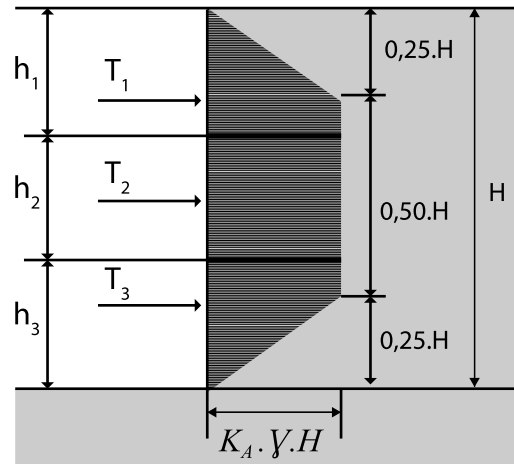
CONSTRUCCIÓN DE TABIQUES Y ANCLAJES ENTRE CONTRAFUERTE
